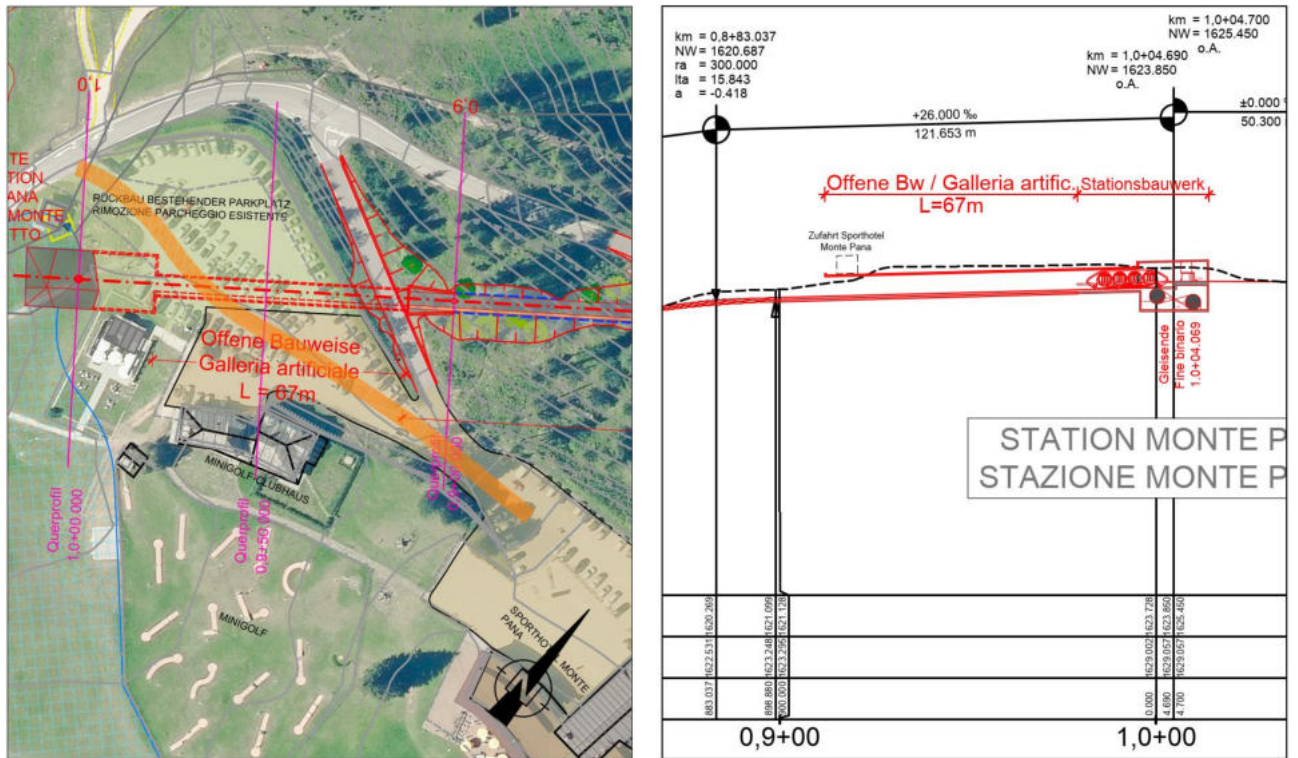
Auszug Lageplan und Längenschnitt Unterquerung Zufahrt Sporthotel Monte Pana
